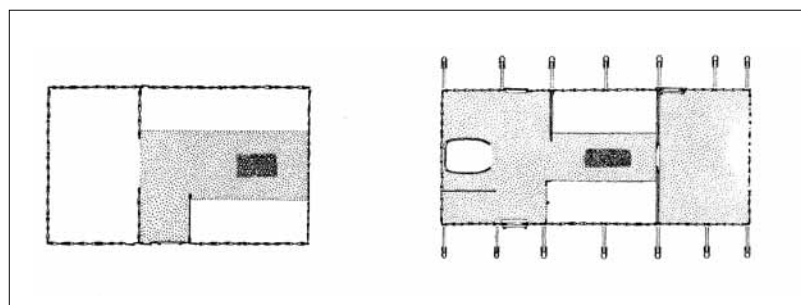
Zwei- und dreizoniger Grundriss aus Haithabu.
